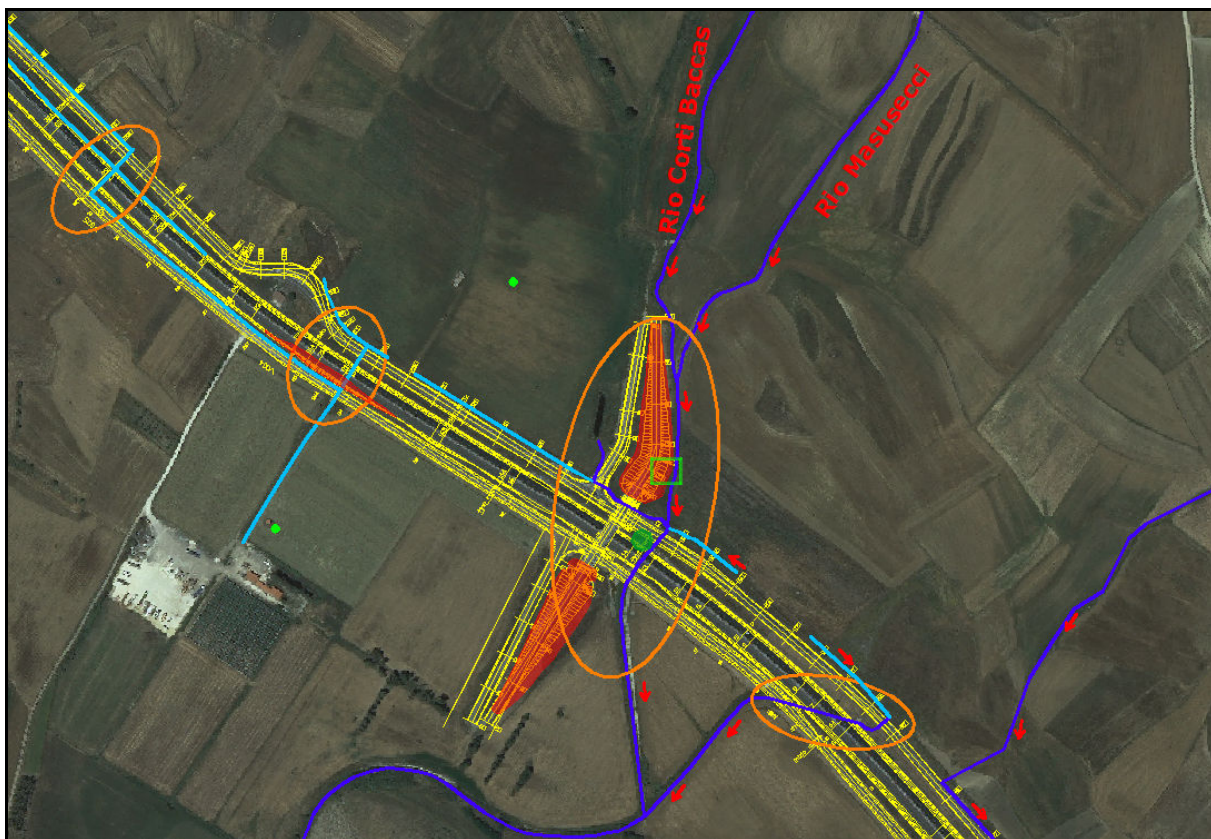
sistema di drenaggio tra la sez. 6 e la sez. 17
